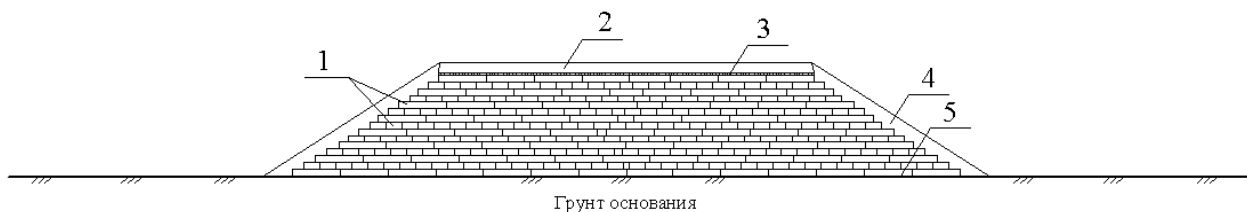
Конструктивная схема насыпи из пенополистирола: 1 – блоки из EPS; 2 – дорожная одежда; 3 – бетонная плита; 4 – грунтовое покрытие откосов; 5 – выравнивающий слой песка.
